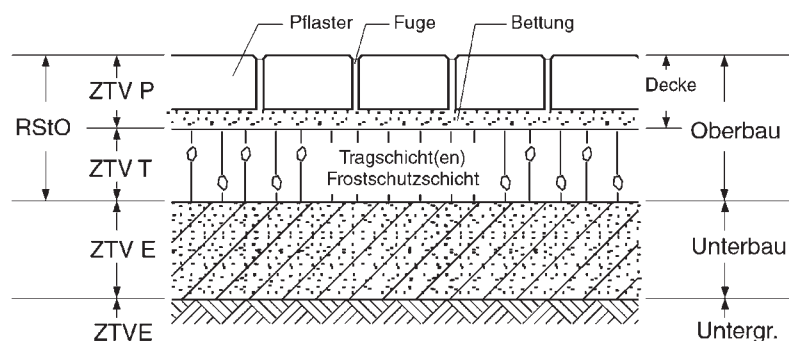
Aufbau einer Pflasterbefestigung und zugehörige technische Regeln.
